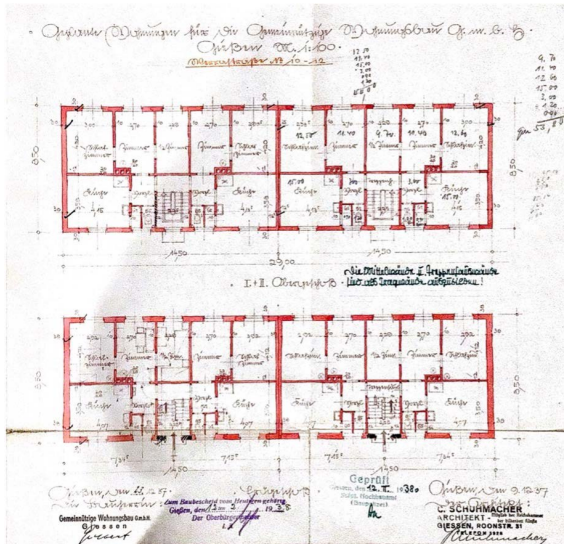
Bauordnungsamt, Grundriss Werrastraße 10/12, 1938.
